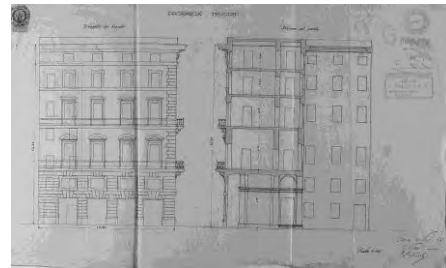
palazzo Trocchi prospetto laterale e sezione sul cortile
